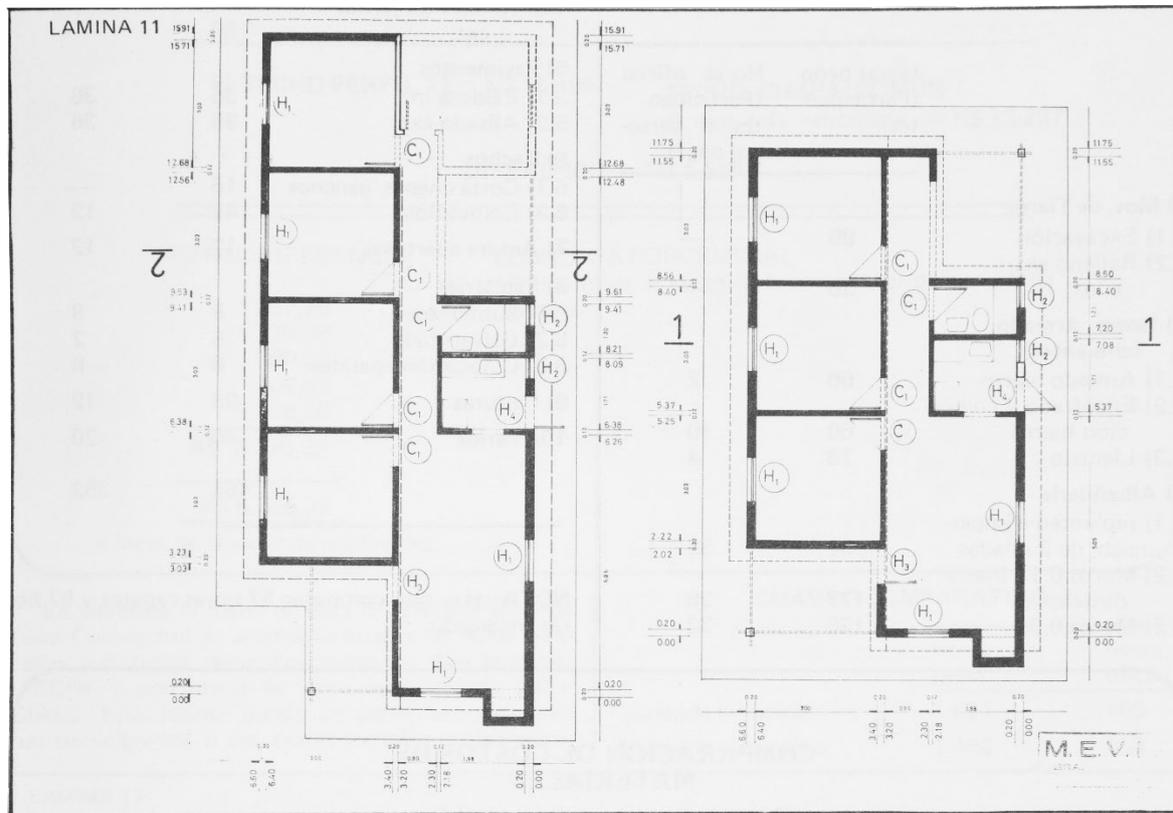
Planta tipo. Folleto Mevir 1968-1983 (1983), p. 15.
